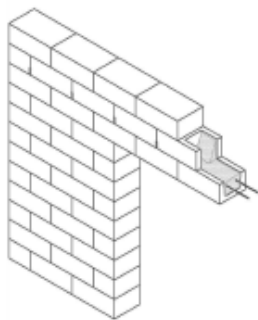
Formazione dell'architrave di porta con blocco a canaletta riempito in calcestruzzo armato
